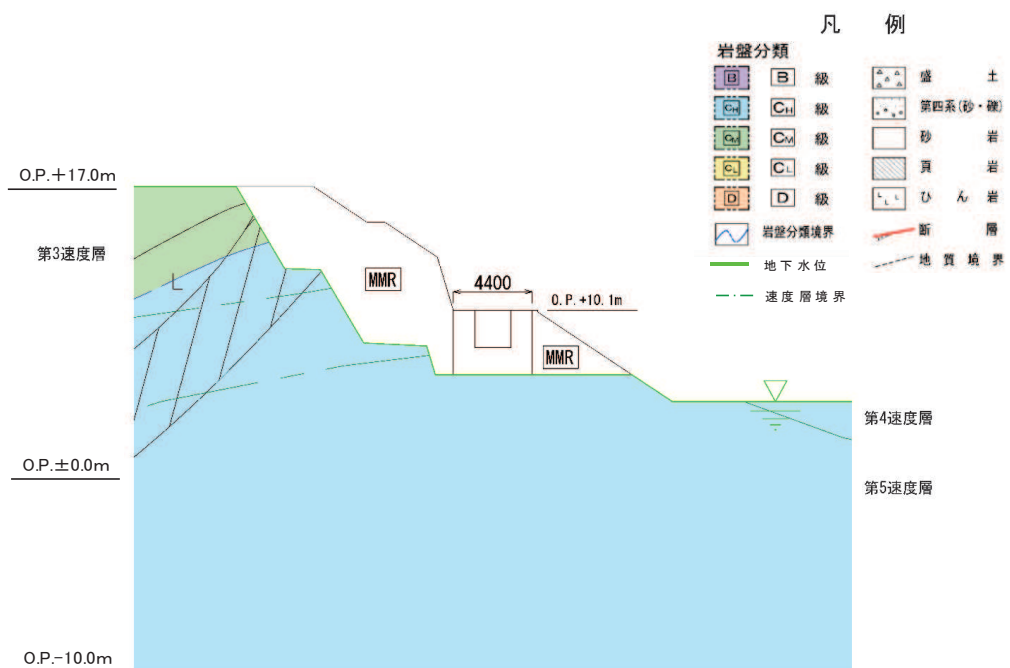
出口側集水ピットの荷重算出断面図 (A-A 断面)
